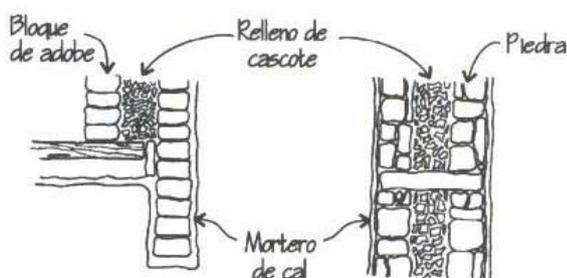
Sección vertical del muro de carga de la casa-torre. A la izquierda, muro de adobe en encuentro con forjado y formación de hueco en pisos superiores; a la derecha, sección de muro de piedra en planta baja (Neila González, 2004).
